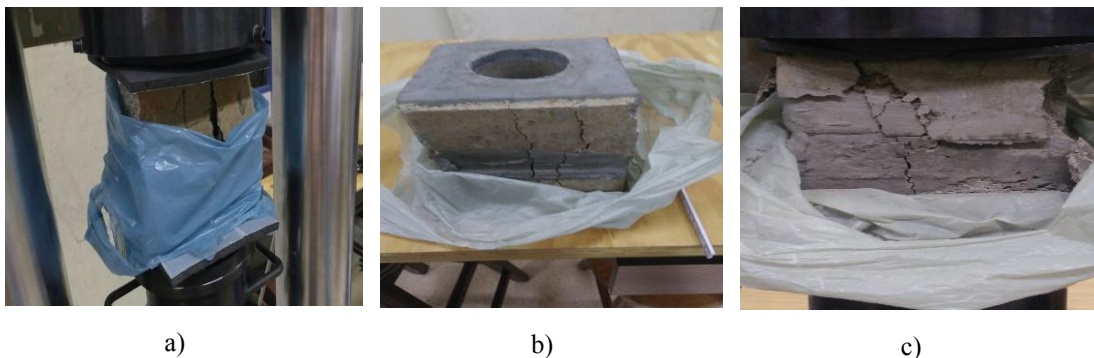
a) primeiro tijolo; b) segundo tijolo; c) Terceiro tijolo
